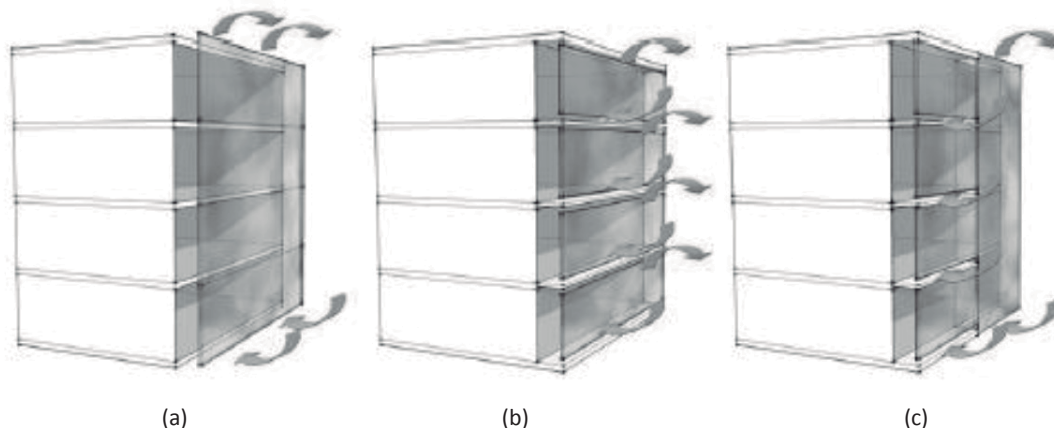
Tipologias de fachada ventilada: a) fachada de múltiplos pavimentos, b) fachada corredor e c) fachada com *shaft* vertical (Mazzarotto, 2011).
